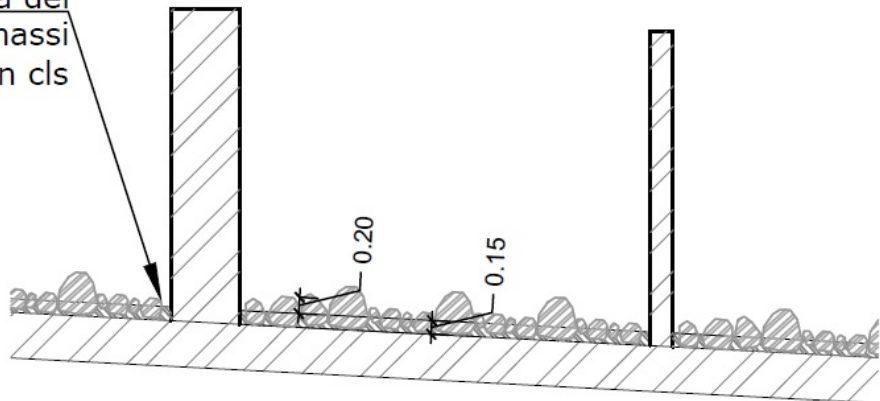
Sezione tipologica realizzazione substrato di rivestimento del fondo
